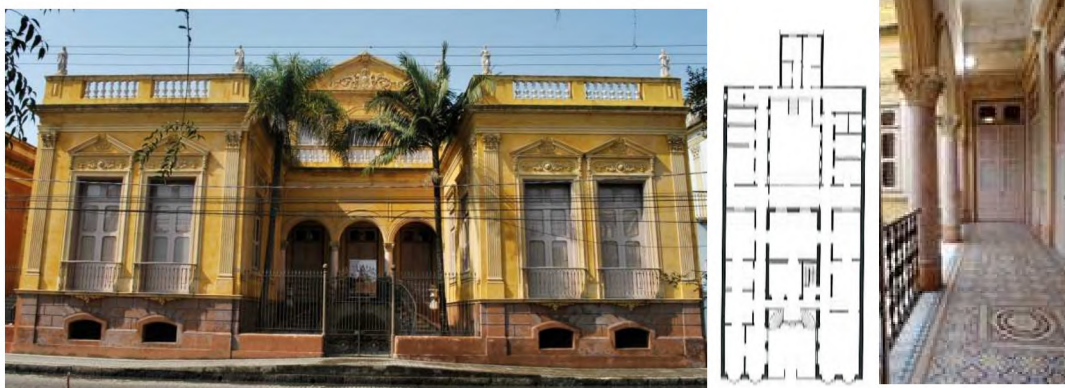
À esq., fachada do casarão, ao centro planta baixa, à dir., desenho completo do tapete do alpendre.
